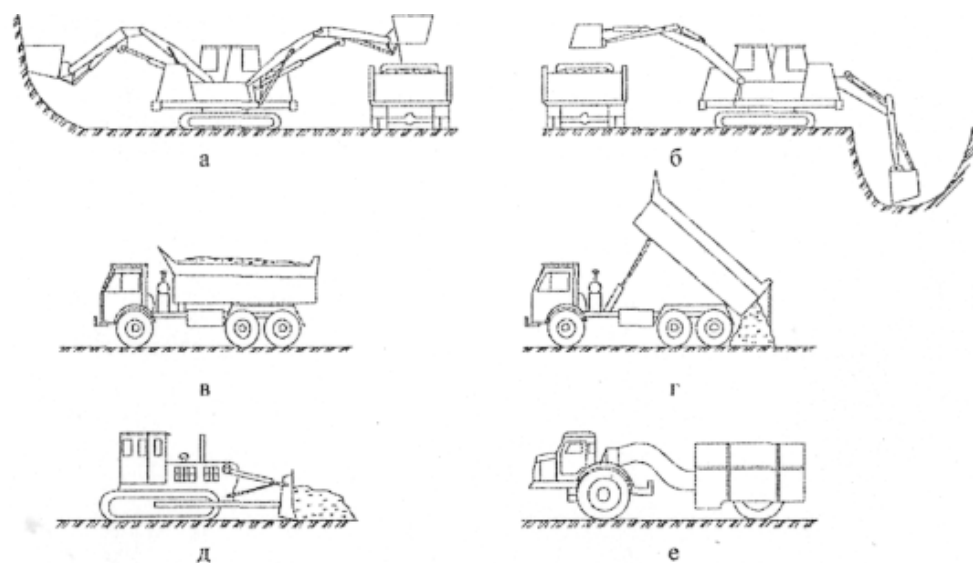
Схема комплексной механизации земляных работ при разработке грунта экскаватором: *а* – разработка грунта экскаватором (прямая лопата) с погрузкой в транспортное средство; *б* – то же (обратная лопата); *в* – транспортирование грунта; *г* – разгрузка; *д* – разравнивание грунта бульдозером; *е* – уплотнение грунта катком
